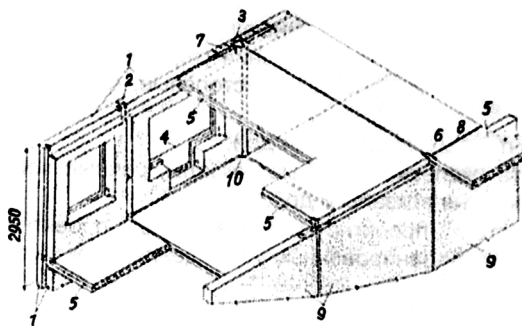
Элементы конструкций бескаркасных домов с несущими продольными стенами:
